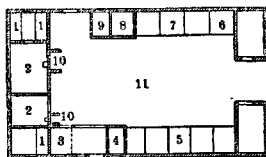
План крестьянского двора немецкого фермера (Шлезвиг-Гольштейн): 1 — нипа для кроватей; 2 — жилые комнаты; 3 — пристройка; 4 — молочная; 5 — коровник; 6 — овчарня; 7 — конюшня; 8 — комната рабочего; 9 — кладовая; 10 — очаг; 11 — двор.
